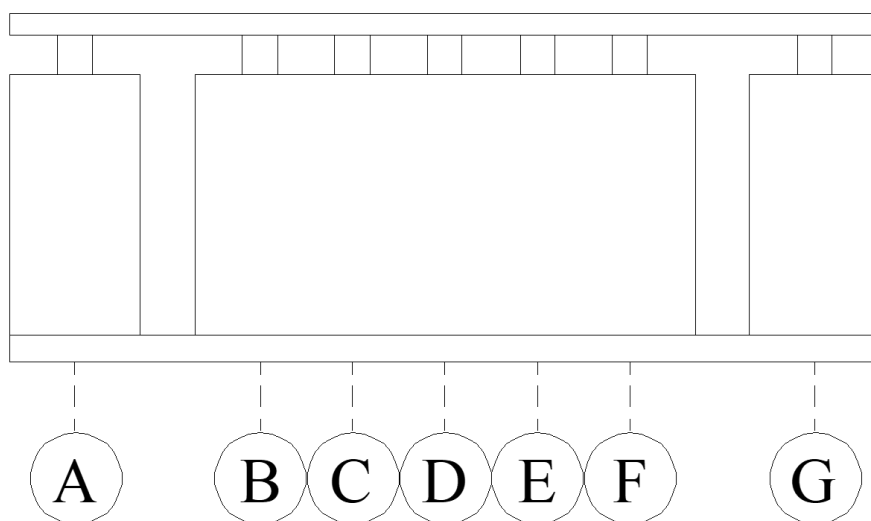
Estructuración longitudinal del puente. 02 vigas continuas.
